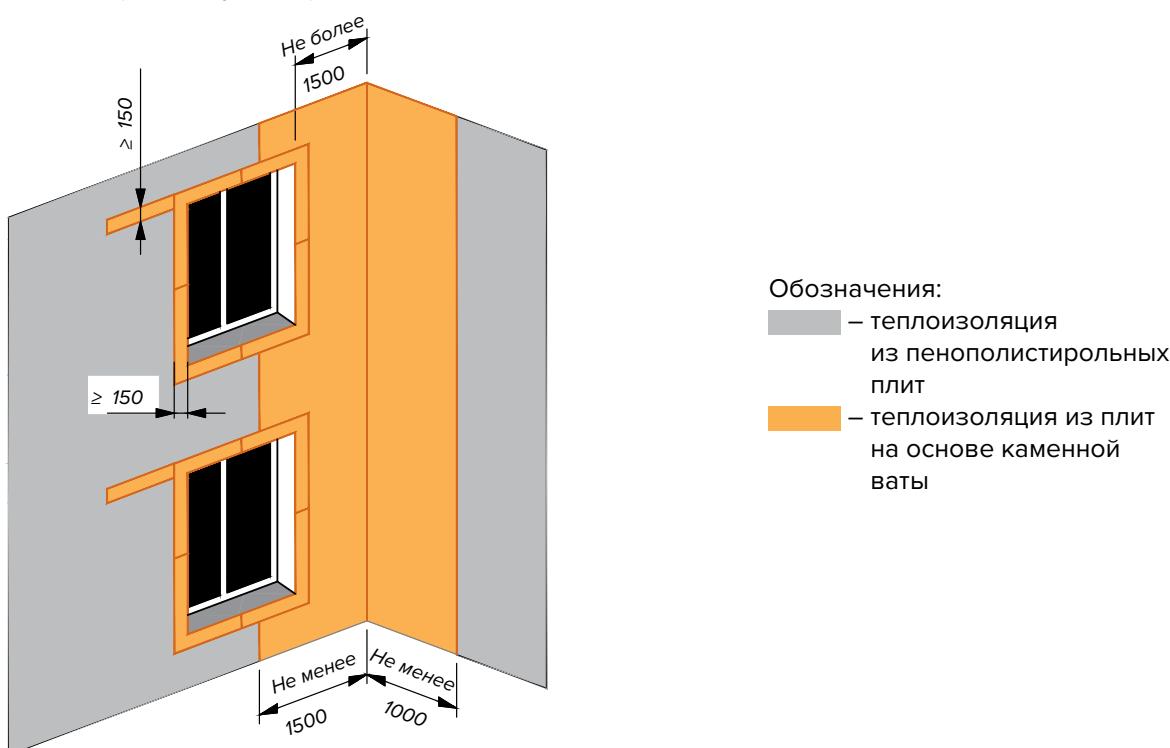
Размещение теплоизоляционных плит в зоне внутреннего угла, при наличии проемов
